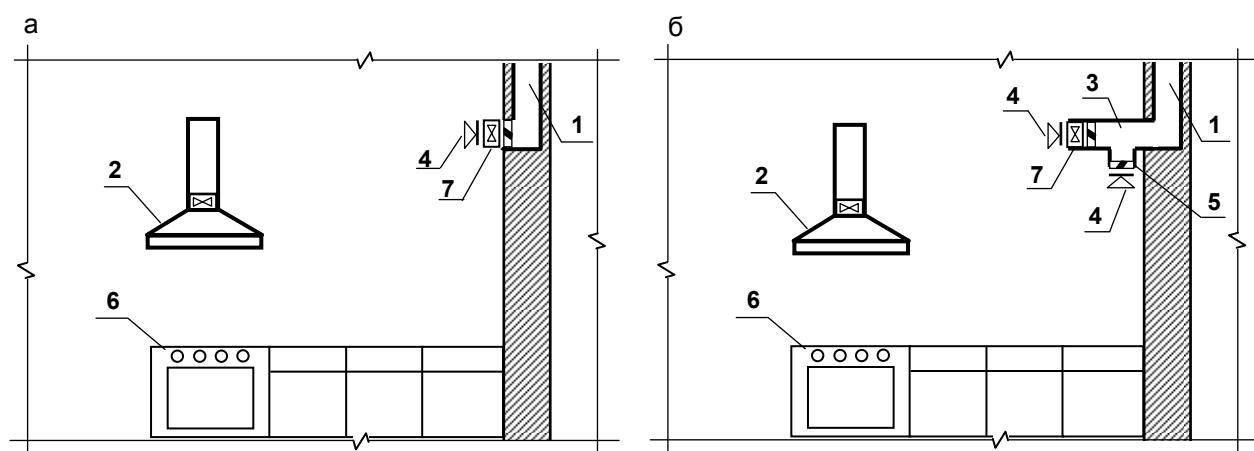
Схемы оснащения вытяжных вентиляционных каналов кухонь с автономными вытяжными зонтами: а – с вытяжным вентилятором; б – с вытяжным вентилятором и дополнительным ответвлением для естественной вытяжки (1 – вентиляционный канал; 2 – кухонная вытяжка; 3 – тройник; 4 – вытяжная вентиляционная решетка; 5 – обратный клапан; 6 – кухонная плита; 7 – вытяжной вентилятор)
